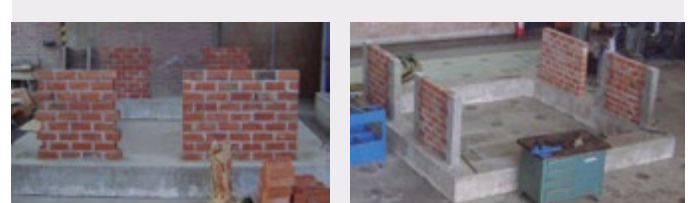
Parapetos analizados. Primero se construyó la albañilería sobre un anillo de concreto.
